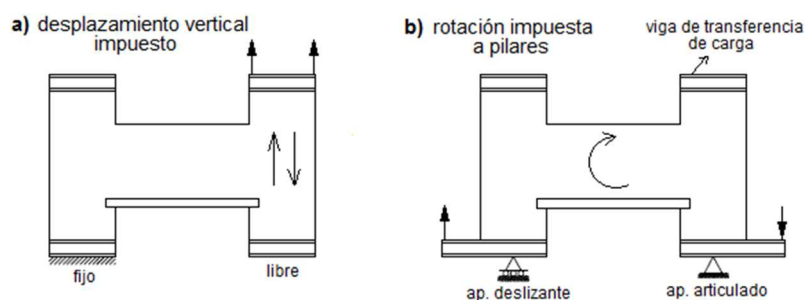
Configuraciones de ensayo sobre vigas-dintel: a) Gattesco et al. (2008); b) Dazio y Beyer (2010)
